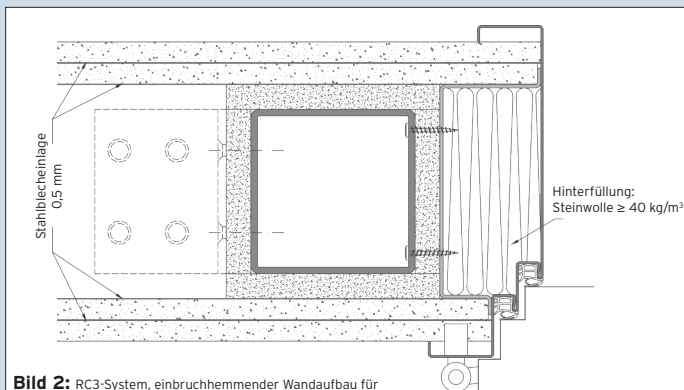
RC3-System, einbruchhemmender Wandaufbau für Stahlumfassungszarge (optional EI_{1,30} mit entsprechender Beplankung)
